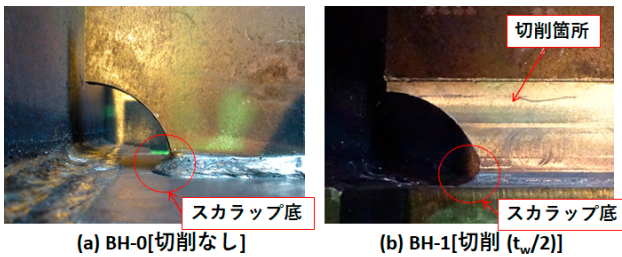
スカラップ近傍の写真 (Photo of near Weld Access Hole)
